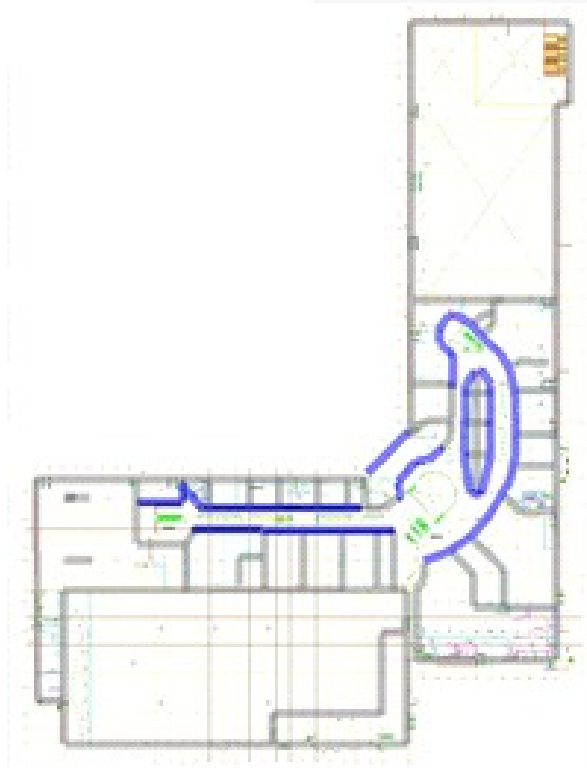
План приміщень 2 поверху. Стіни та перекриття 2 поверху
